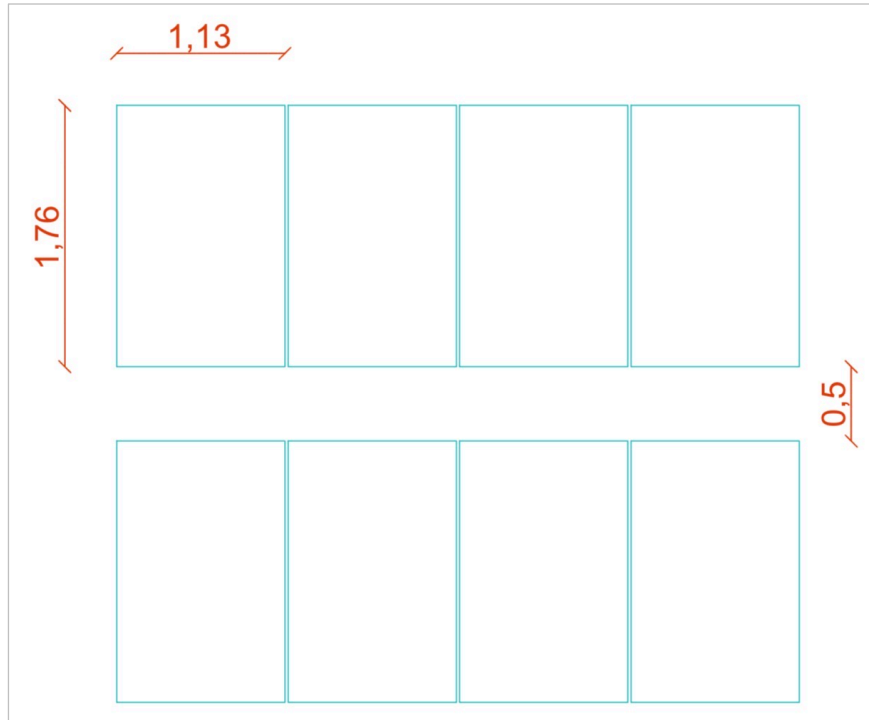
Pianta di una porzione di impianto su Autocad con quotatura (m)
